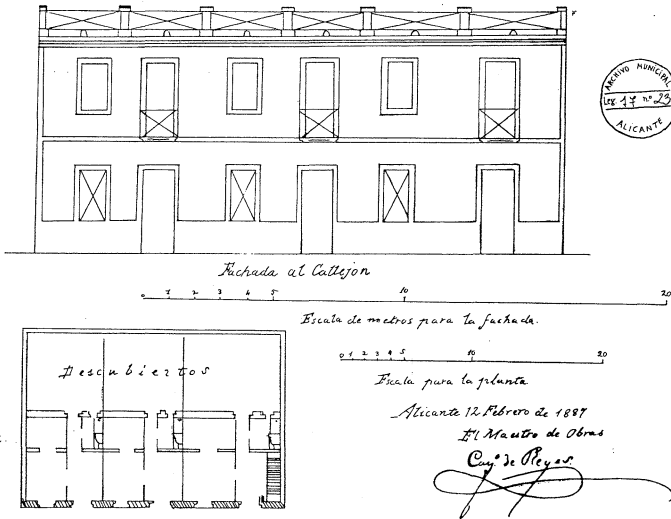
Fachada y planta de las viviendas típicas del barrio.
